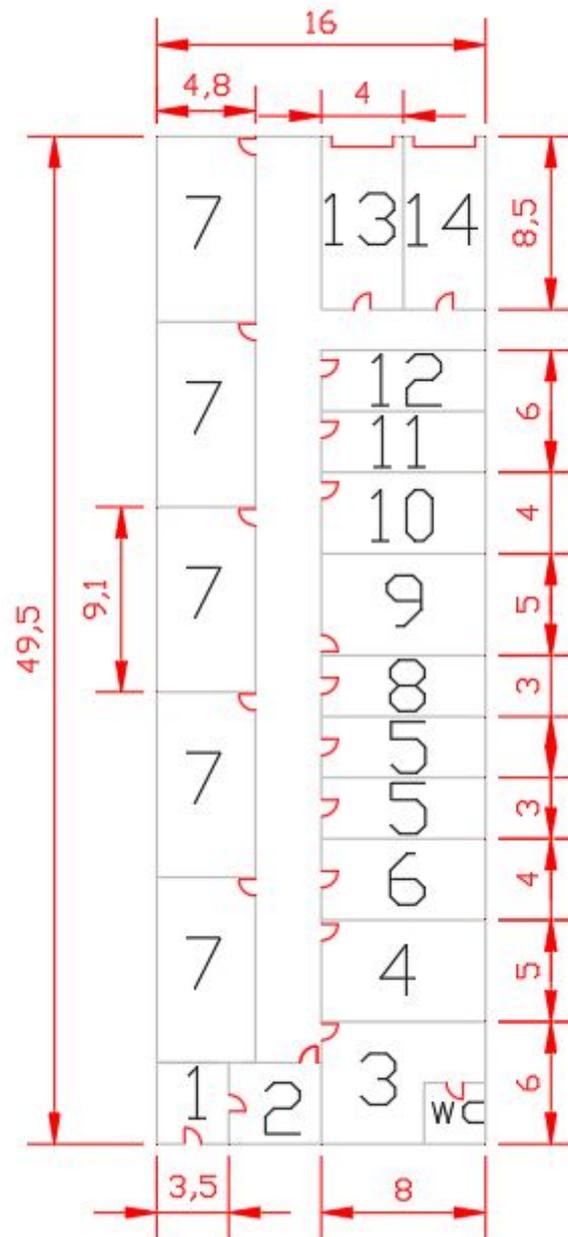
Distribución en planta definitiva. Identificación de secciones (cotas en metros).
